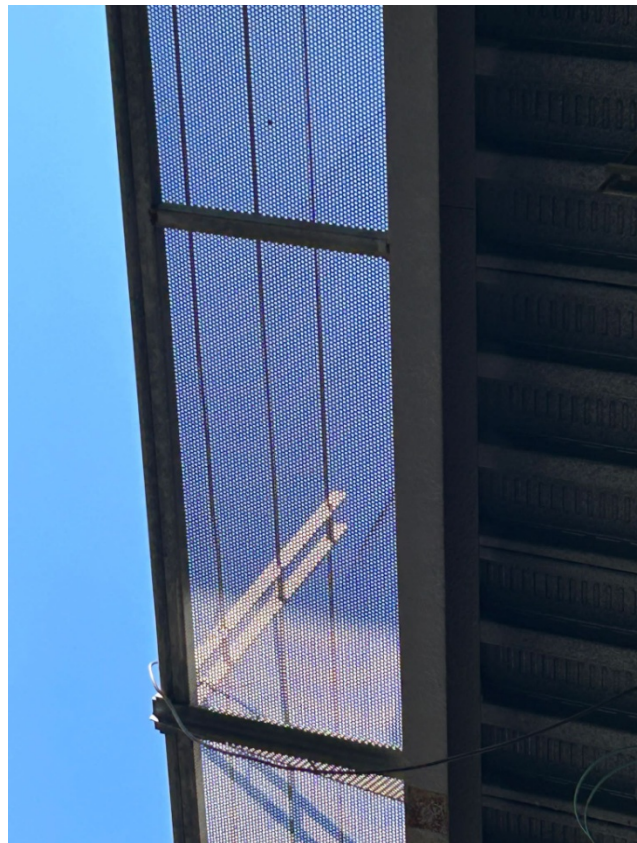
Sección y perspectivas de pasarela de planta primera estado actual
